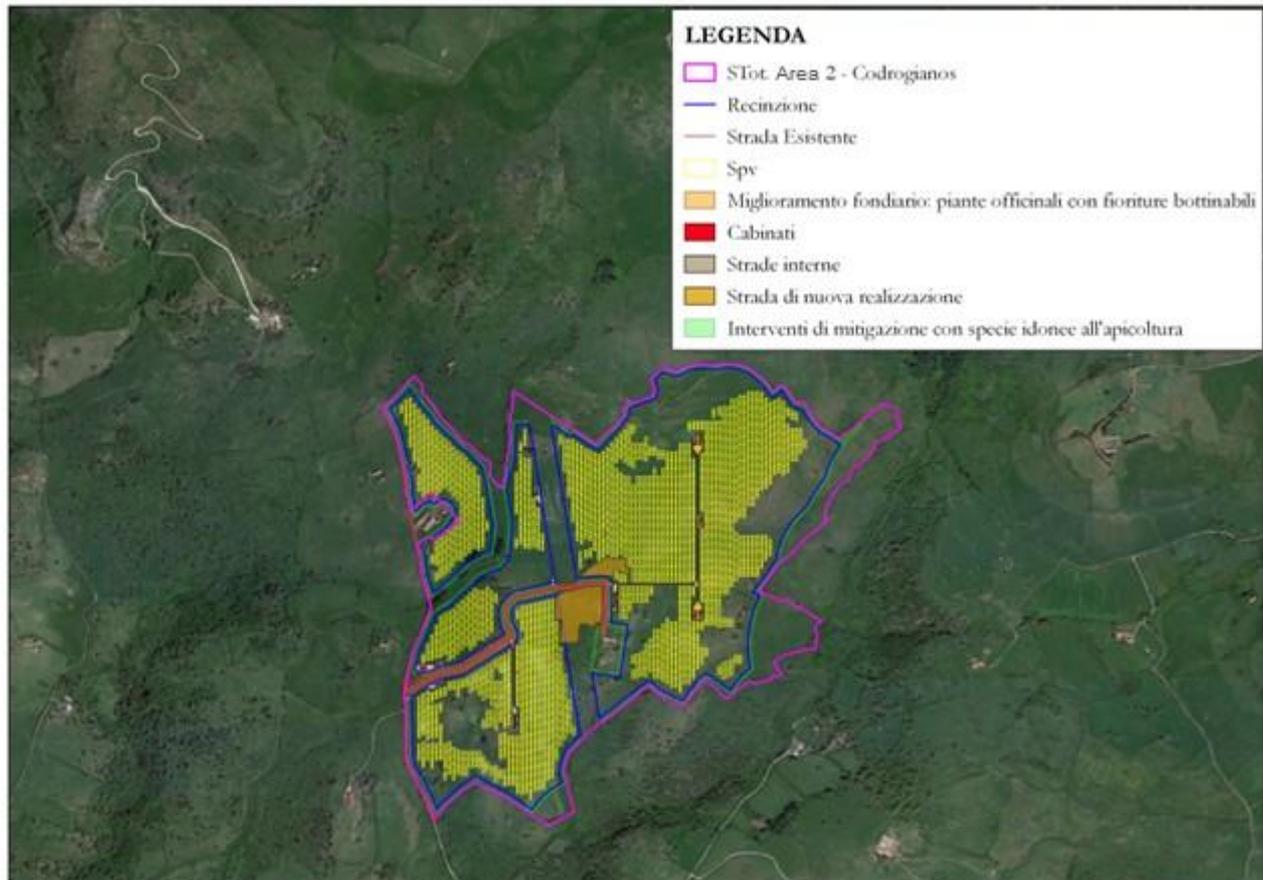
Layout di impianto Area 2 – Codrogianos (SS) con aree di nuova coltivazione di piante officinali quale miglioramento fondiario, da realizzarsi alle dovute distanze rispetto al perimetro della Spv e delle recinzioni.
